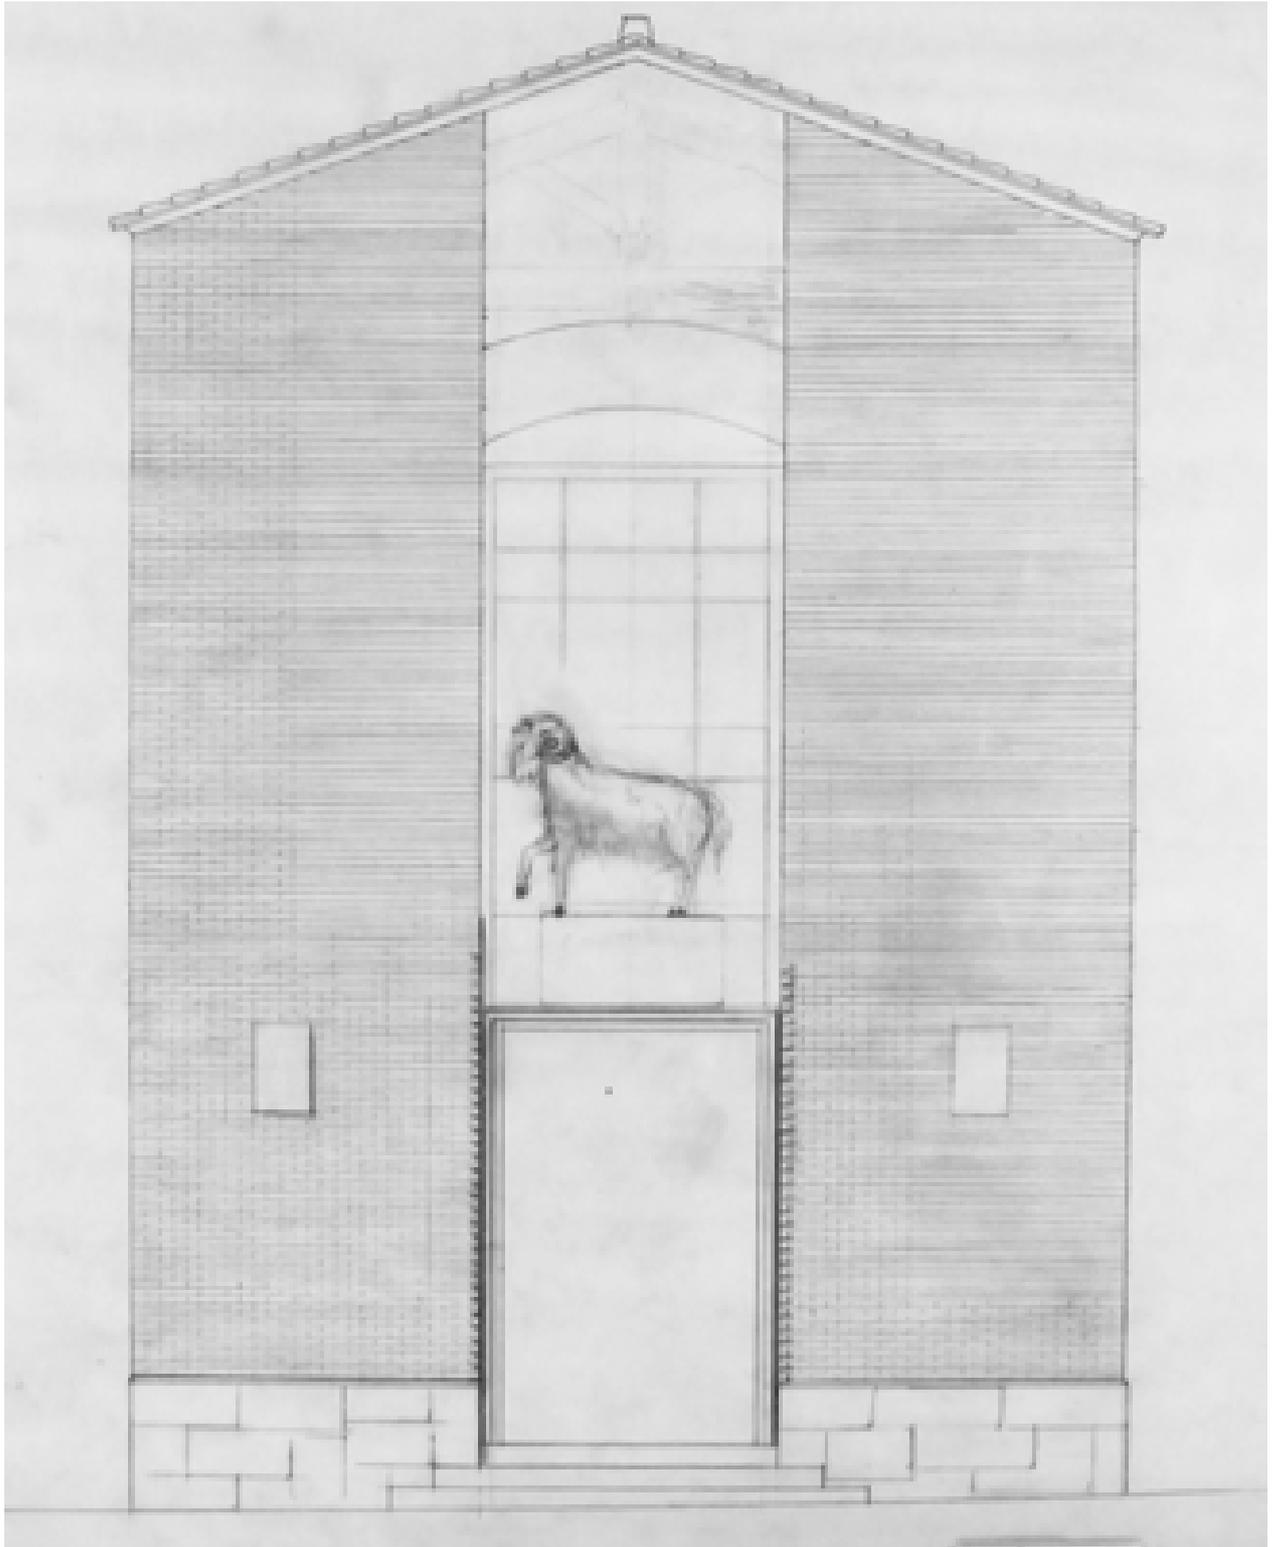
Prospetto Oratorio – s.d. (AABS-94.118)
